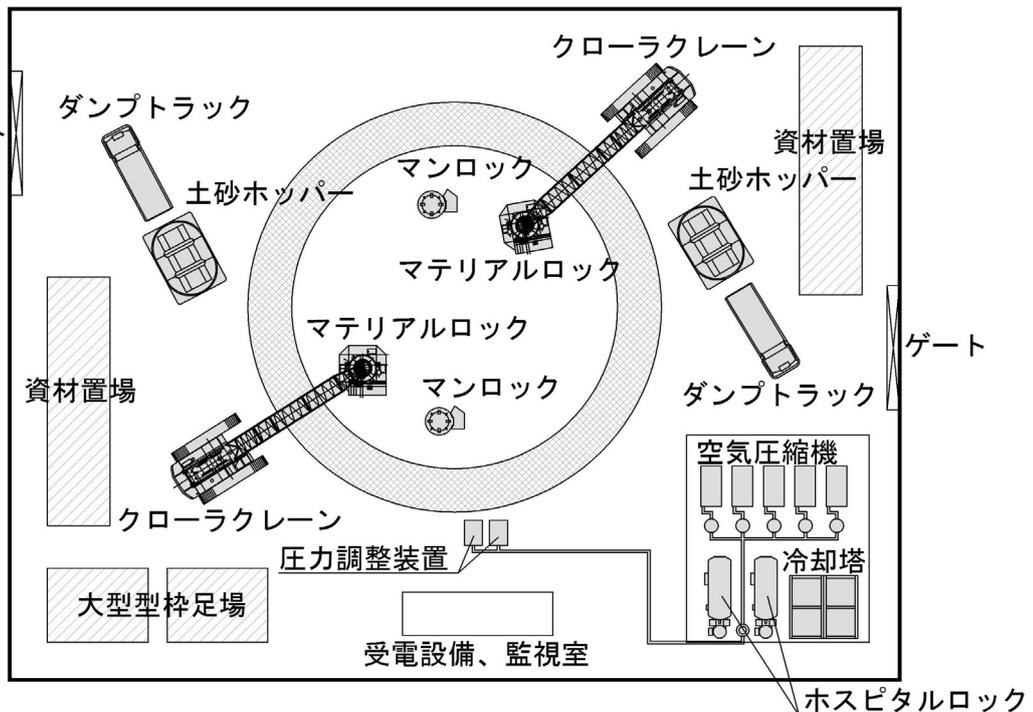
非常口の施工ヤードの概要 (ケーソン工法による非常口施工時)
